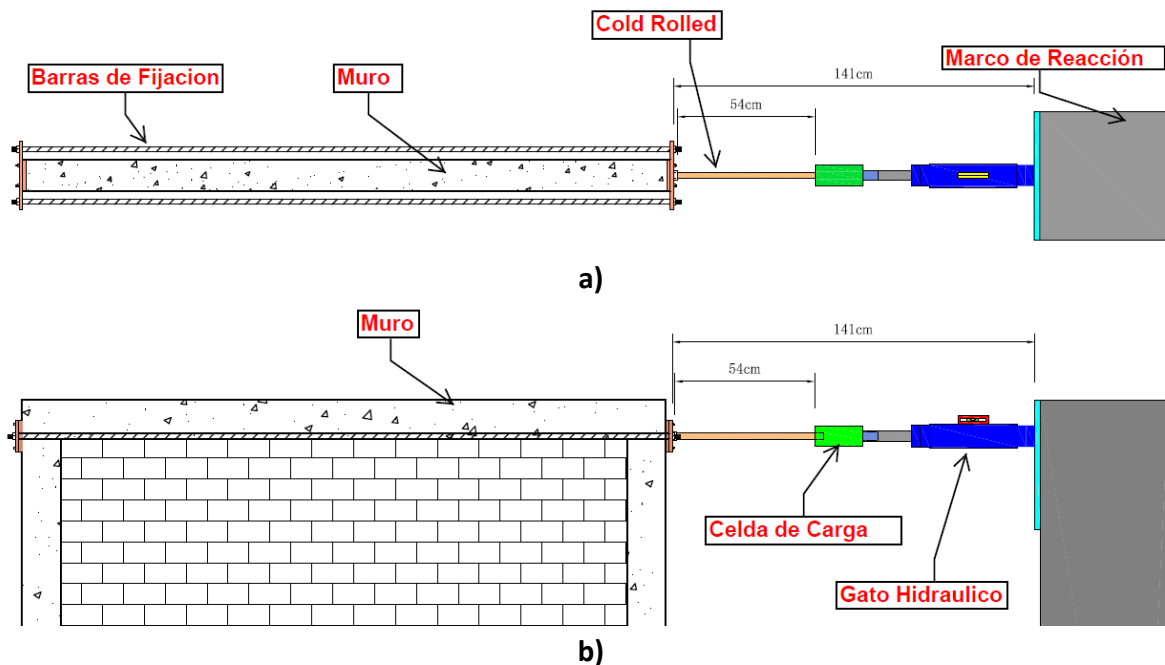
Detalle de dispositivo de carga lateral a) Vista superior b) Vista lateral
